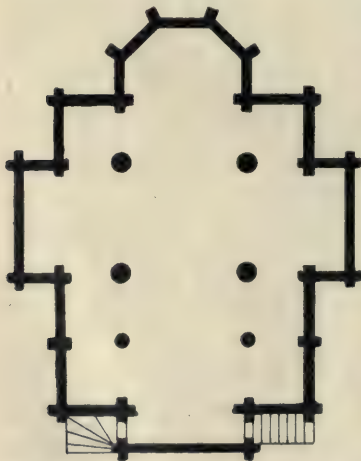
Löwen. Grundriß für eine Kollegskirche.
